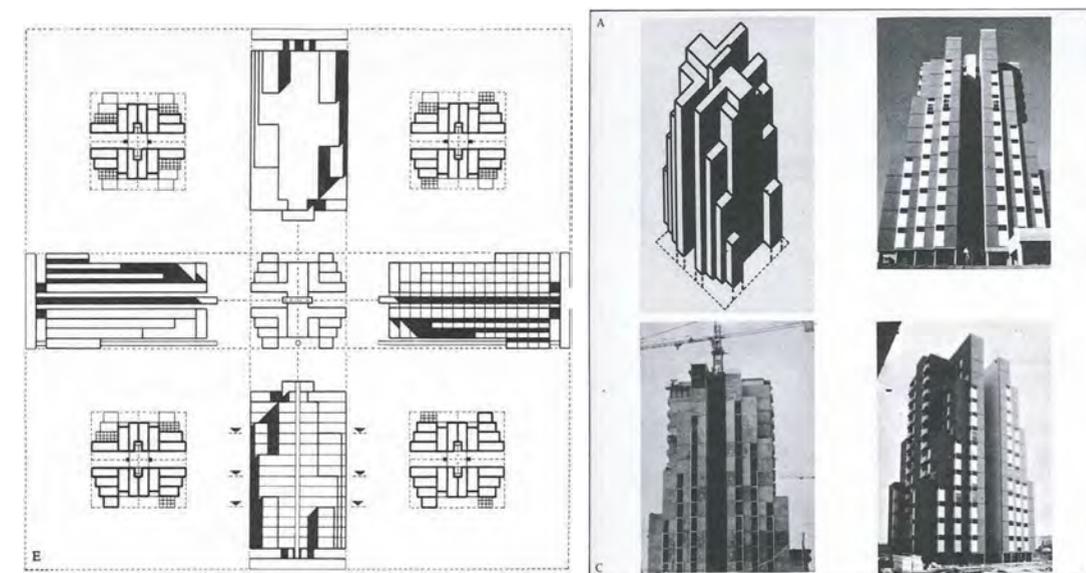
Laurentino, Roma: Tipologie edilizie nel Settore Nord Est - Case a torre (14 piani) - Schemi. Gli edifici costruiti con sistemi a tunnel sono stati progettati da Pietro Barucci. Fondo Pietro Barucci
